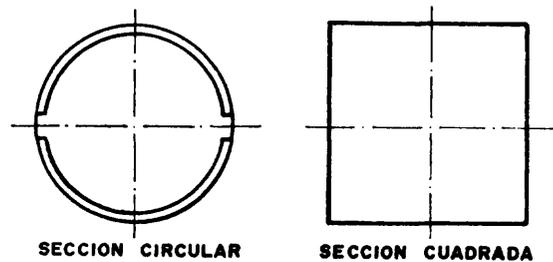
SECCION CIRCULAR SECCION CUADRADA
